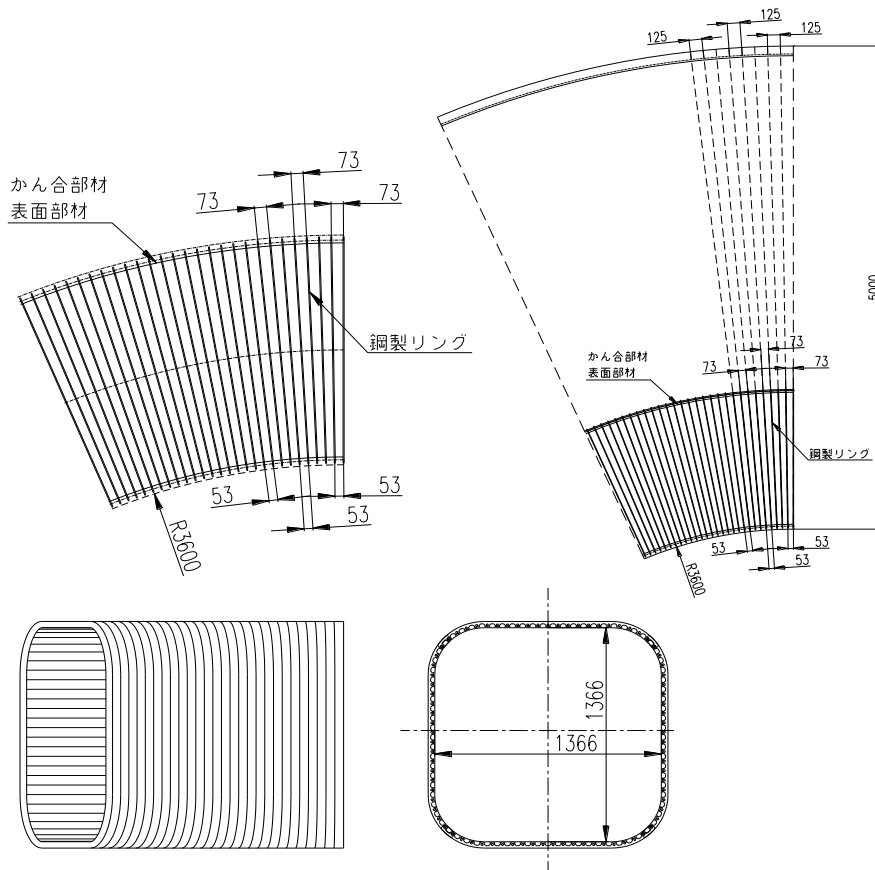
矩形管曲線部の施工性試験の配管図 (単位 mm)
